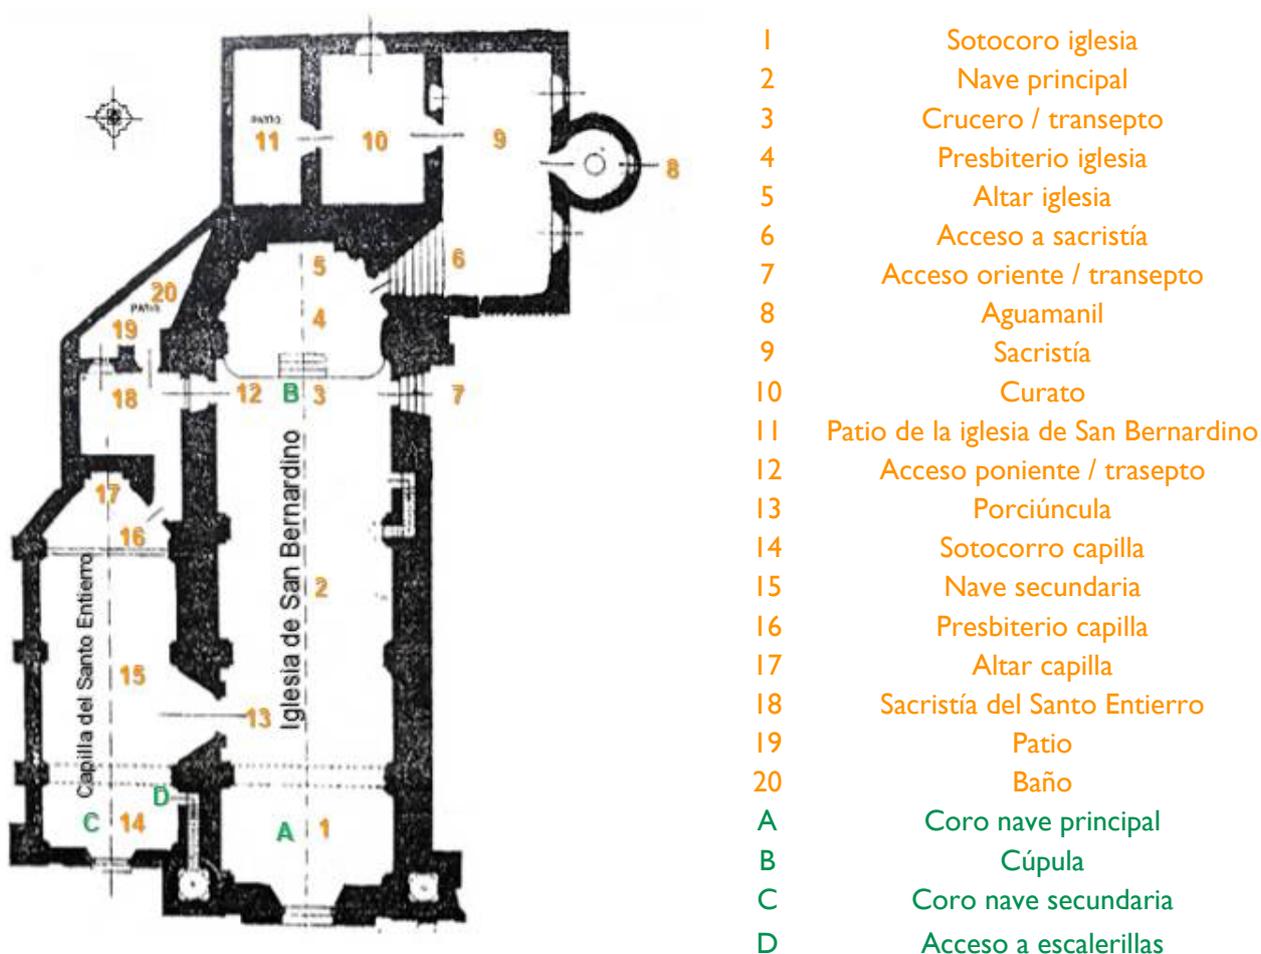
Planta arquitectónica de la iglesia del ex Convento de San Bernardino.
